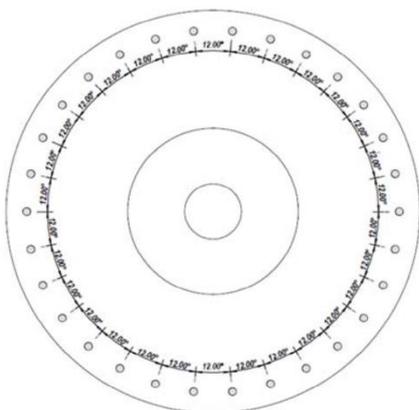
Andamento geometrico della fondazione (pianta – non in scala).
